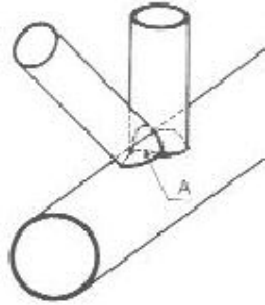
Soldadura de un nudo con recubrimiento parcial
